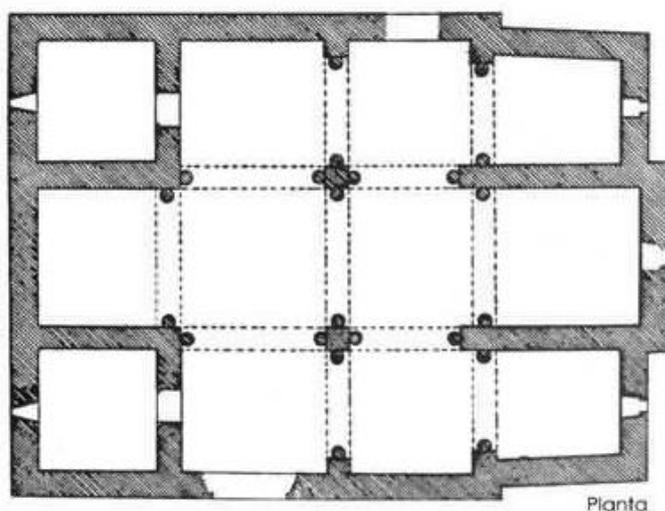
Planta de Santa María de Lebeña⁶⁹
